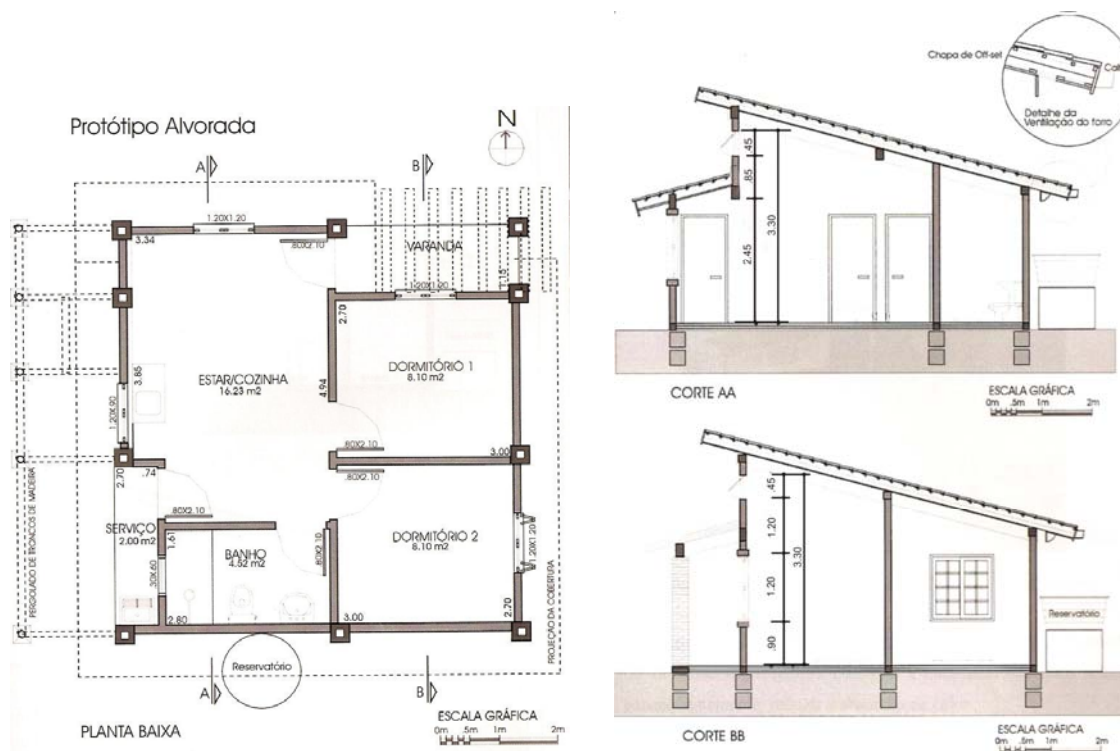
Planta Baixa e Cortes do Protótipo Alvorada.
